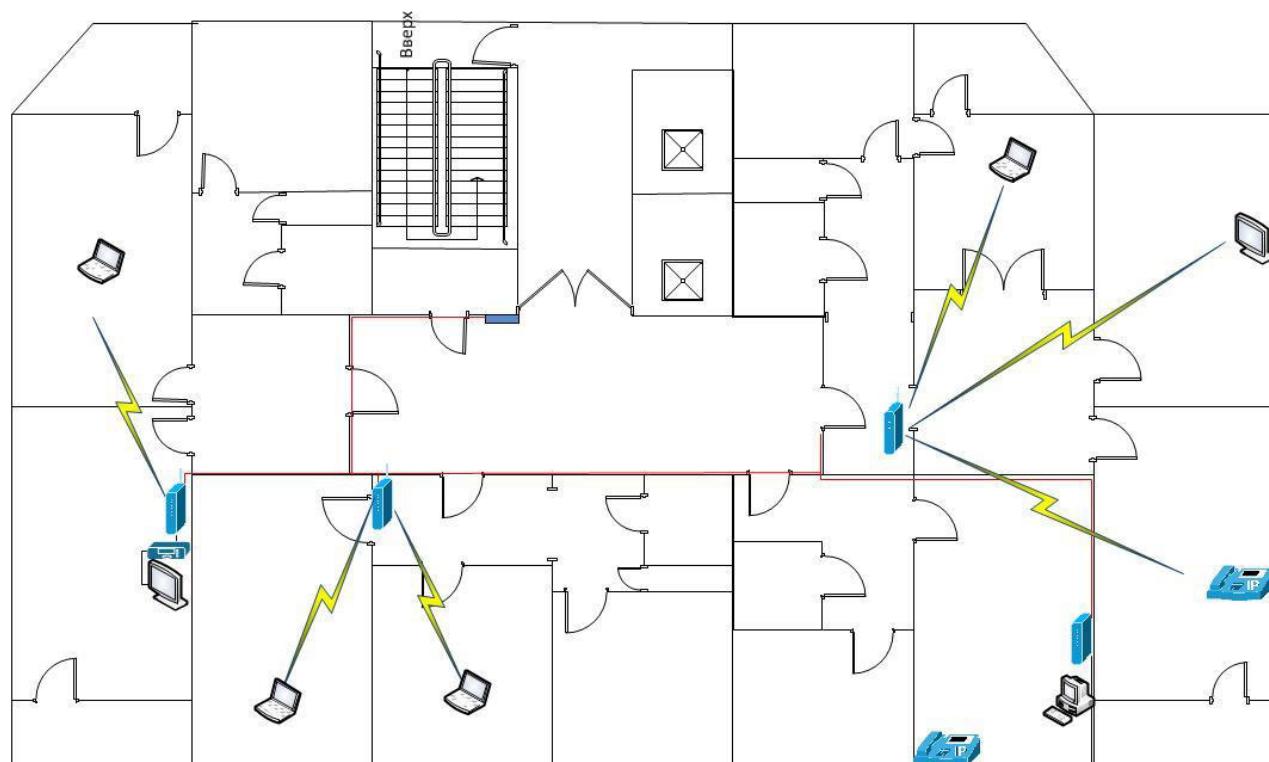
Размещение оборудования доступа в жилом доме на этаже
